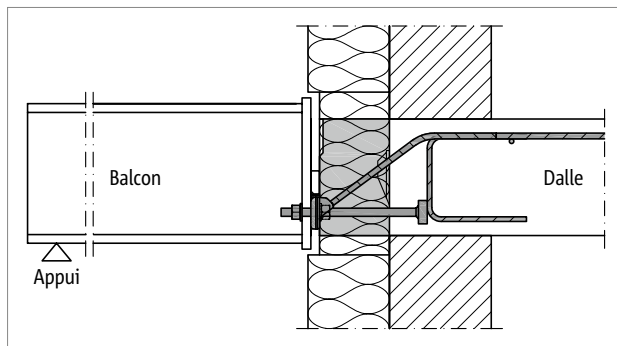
Schöck Isokorb® XT type SQ : raccordement à la dalle en béton armé ; corps isolant à l'intérieur de l'isolation thermique extérieure
